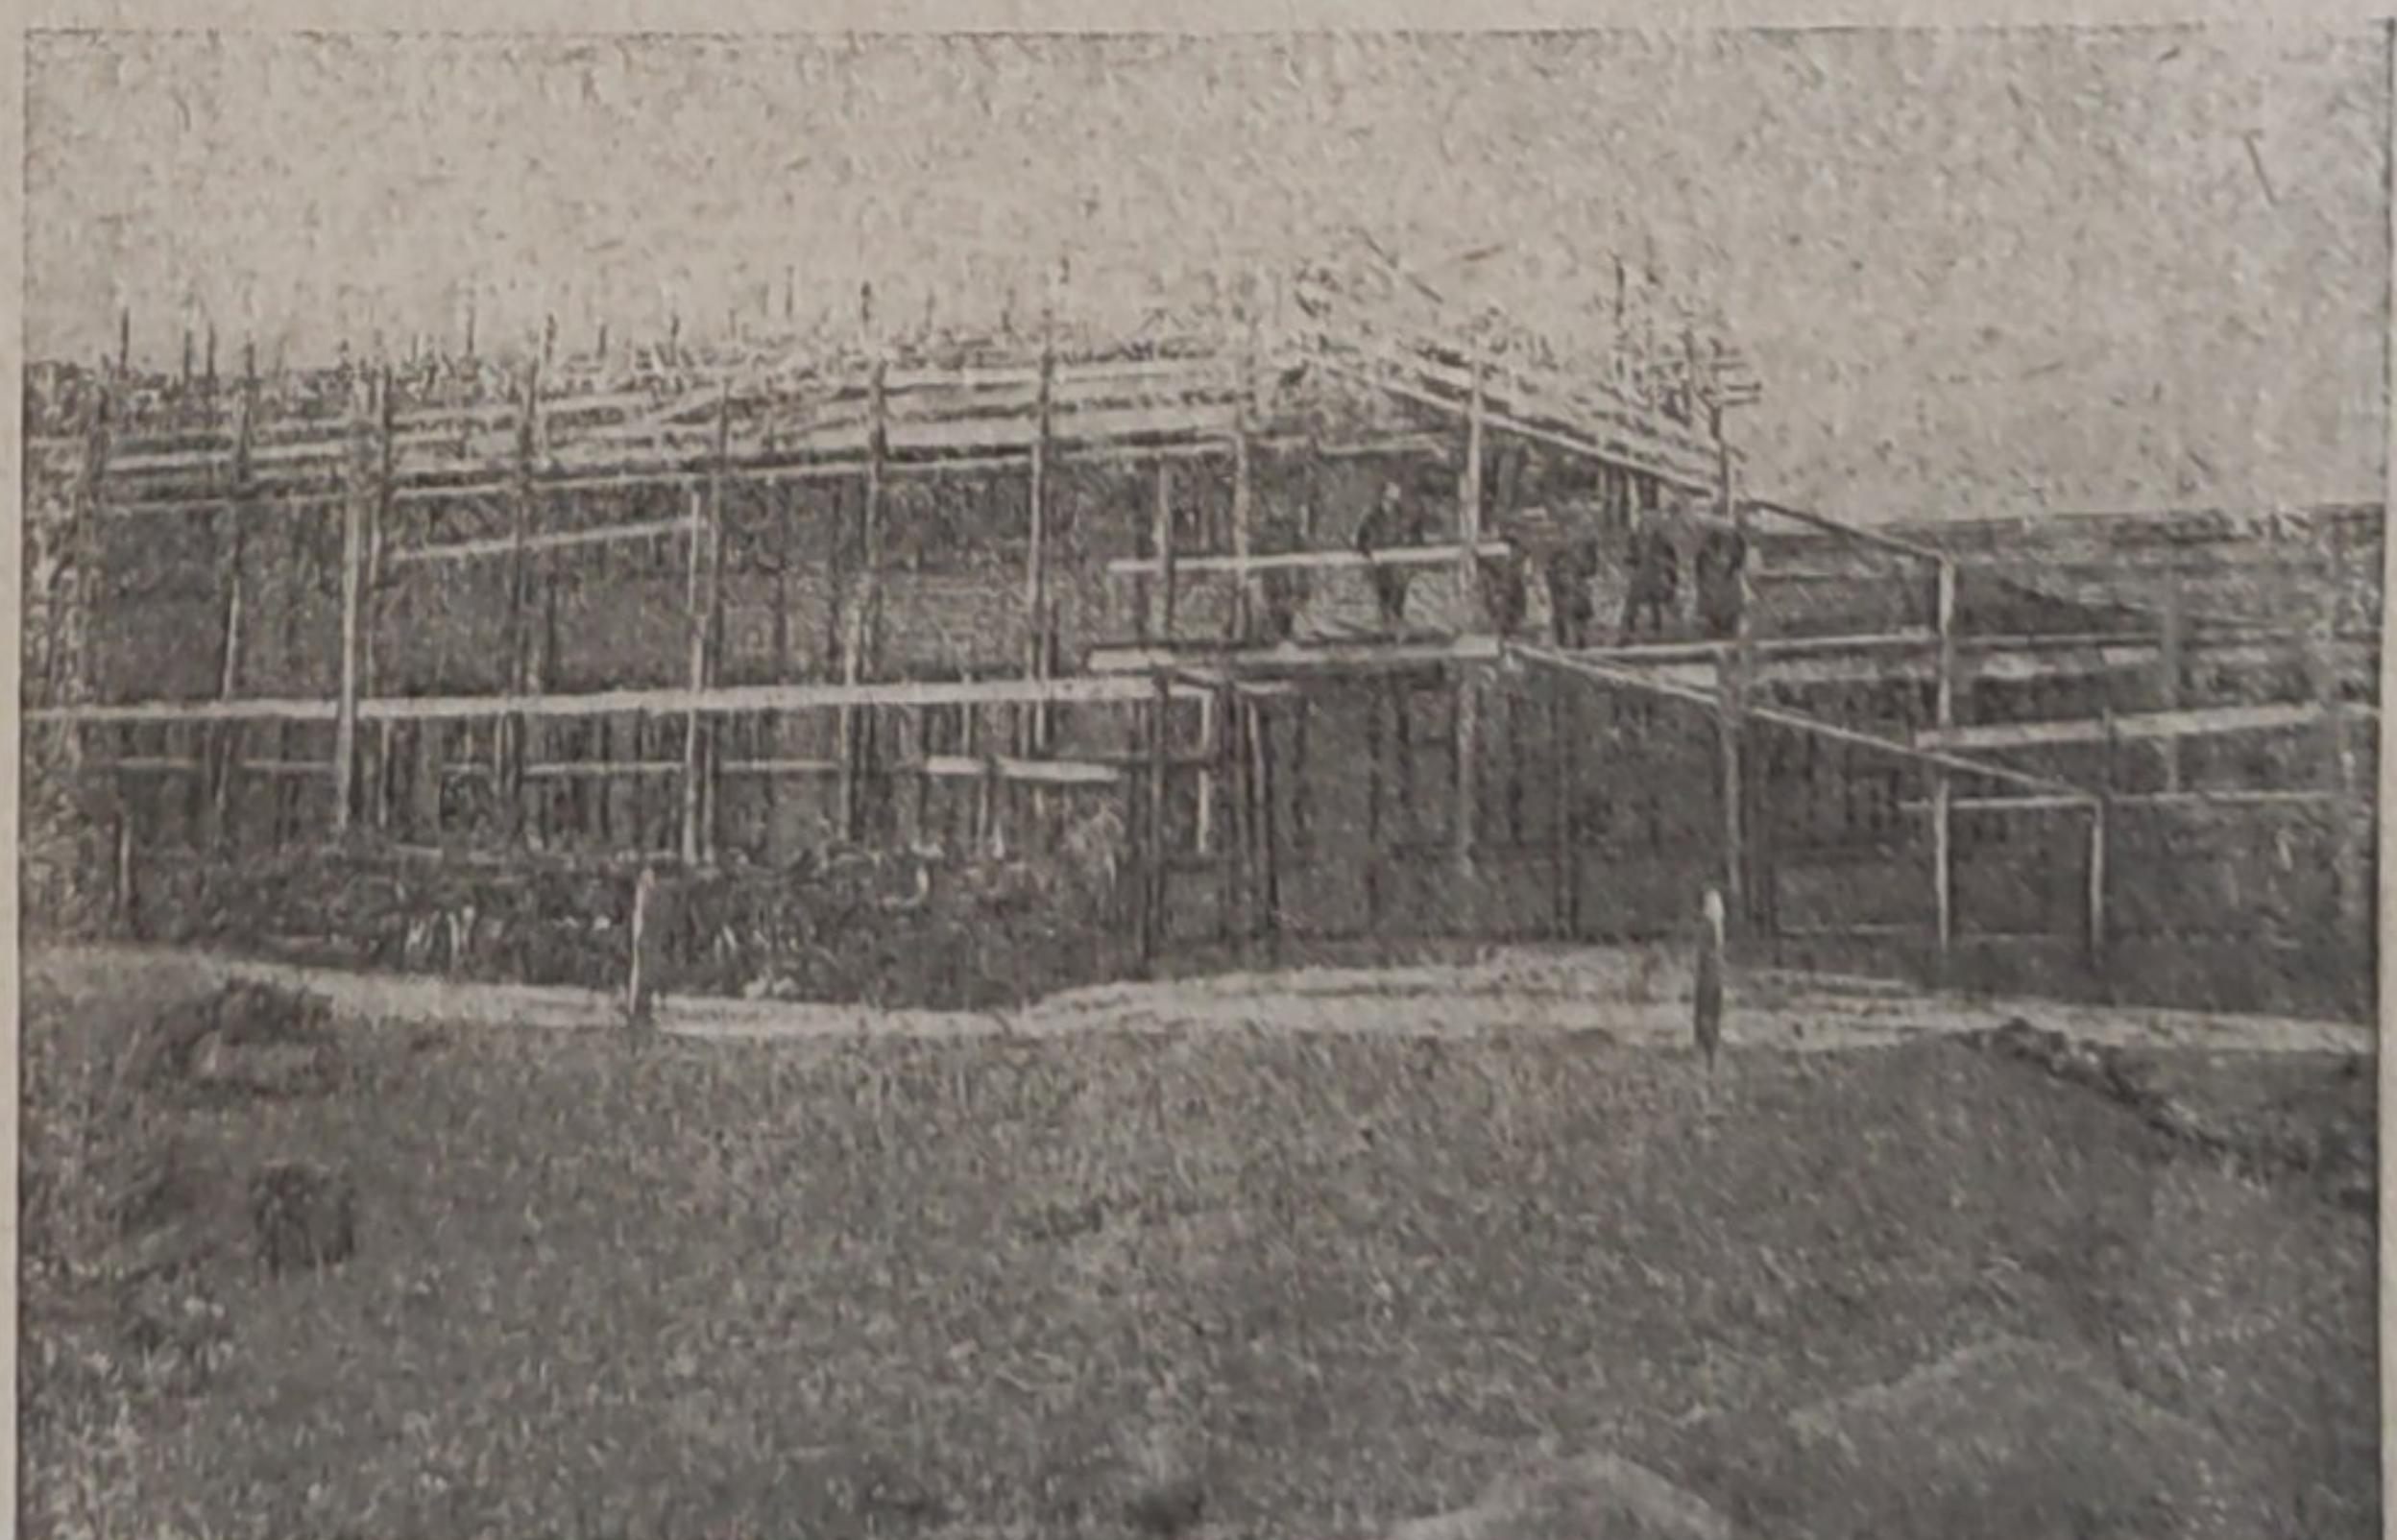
Вид строящегося корпуса со стороны озера Шапор
